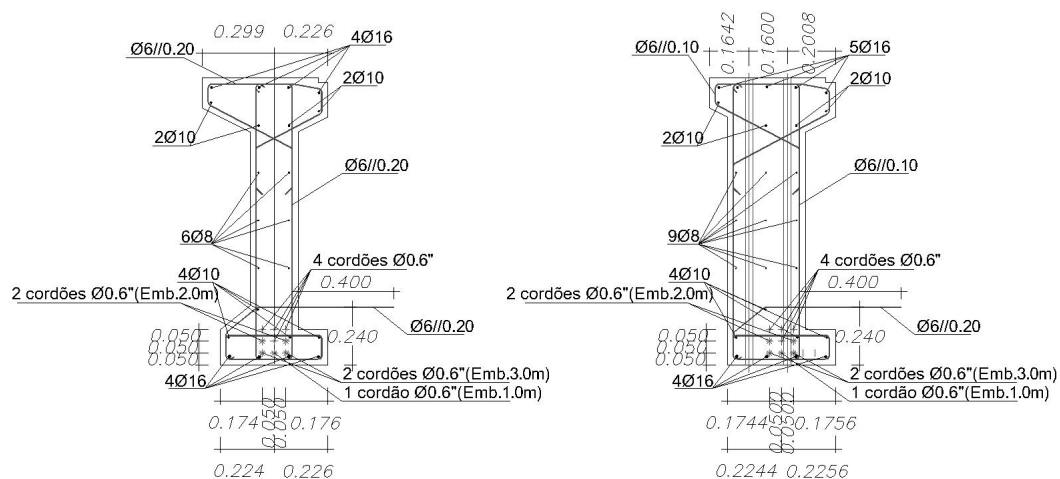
Pormenorização das armaduras das vigas a meio vão e sobre o pilar [18]
